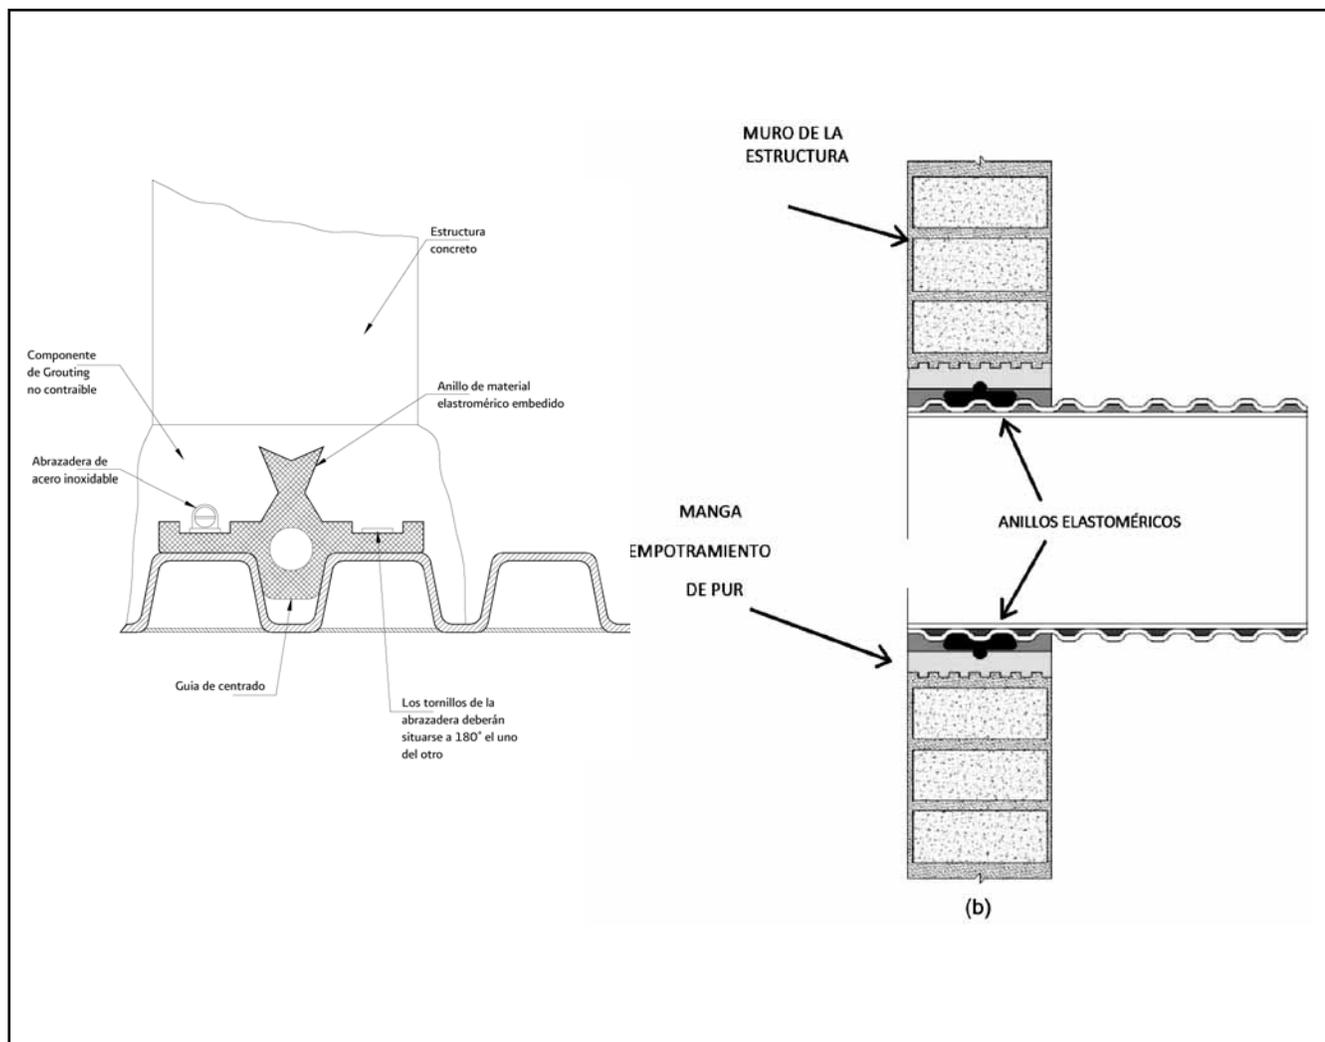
Esquema de instalación de la tubería de PEAD corrugada a una estructura
